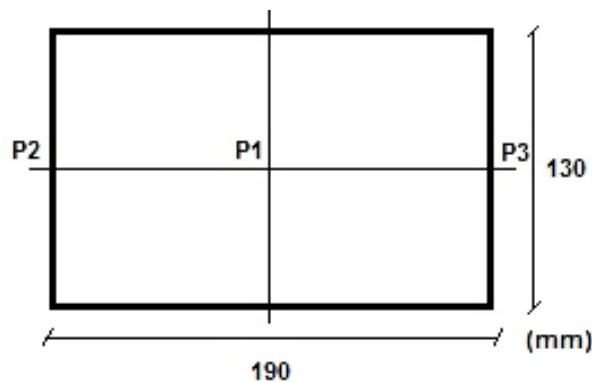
Planta esquemática da localização dos pontos P1, P2 e P3.
